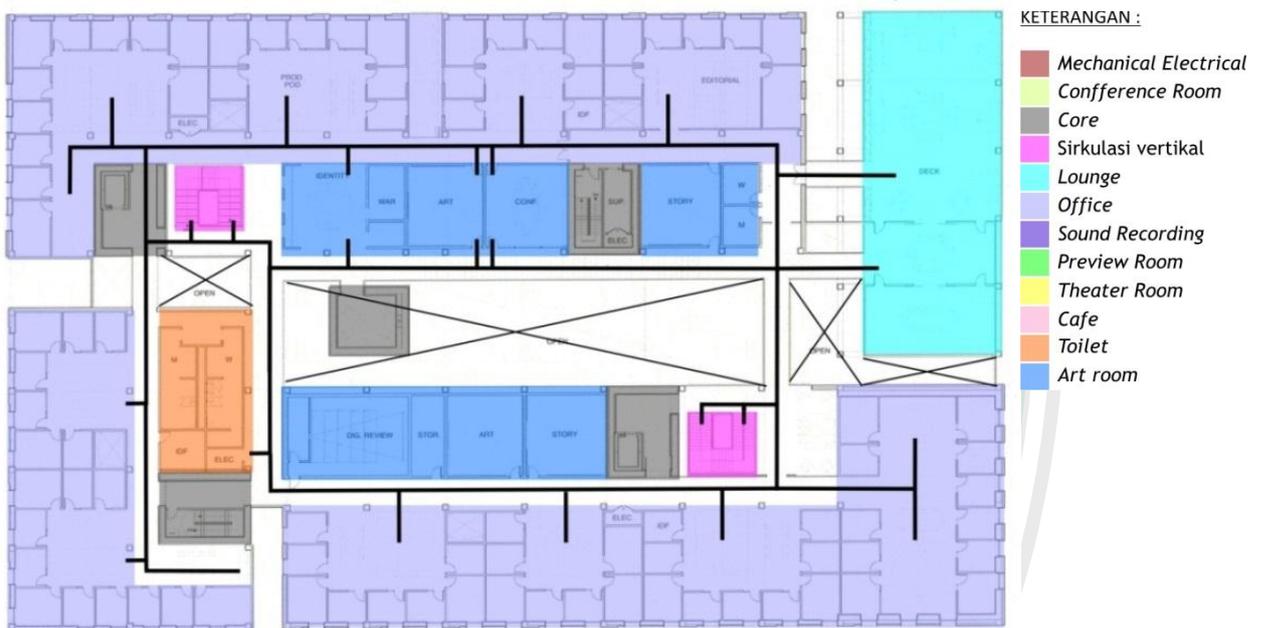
Detail Sirkulasi Denah Lantai 3
